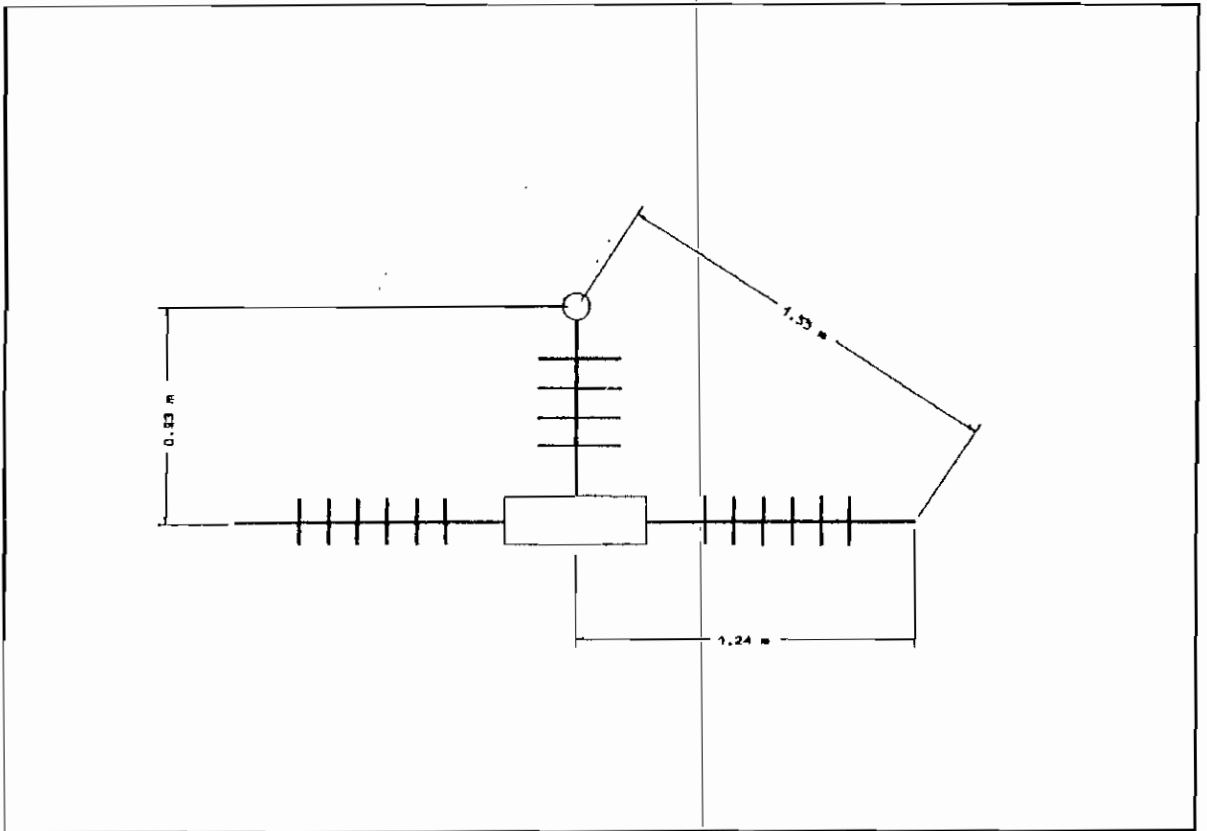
Aislamiento para cada fase de las estructuras de suspensión
